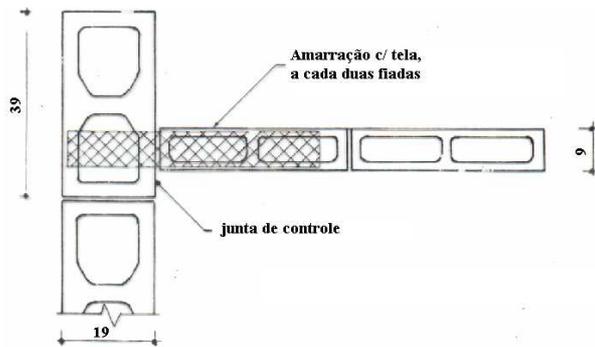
Amarração de junta a prumo com tela metálica
